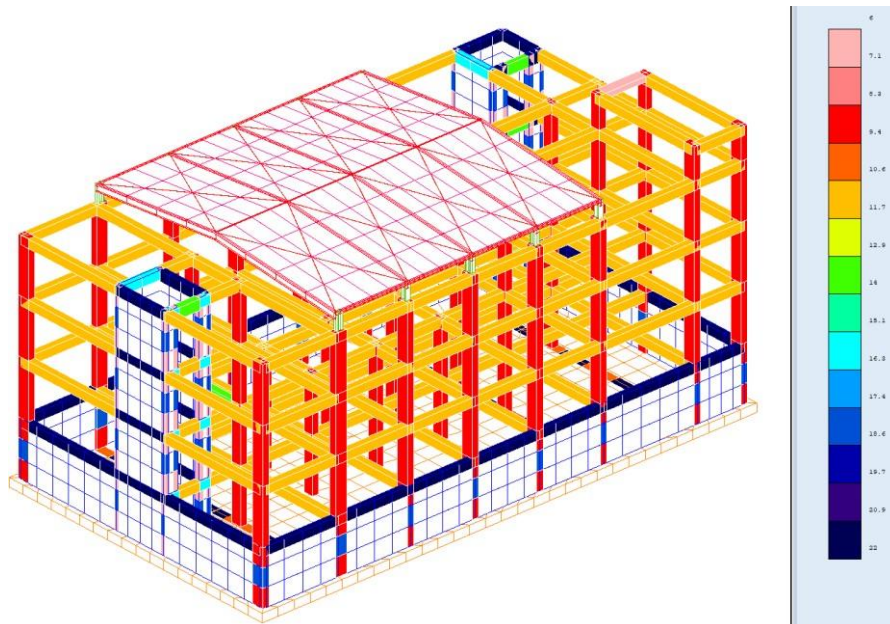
Sipërfaqja e armaturës në prerje për elementët strukturorë
